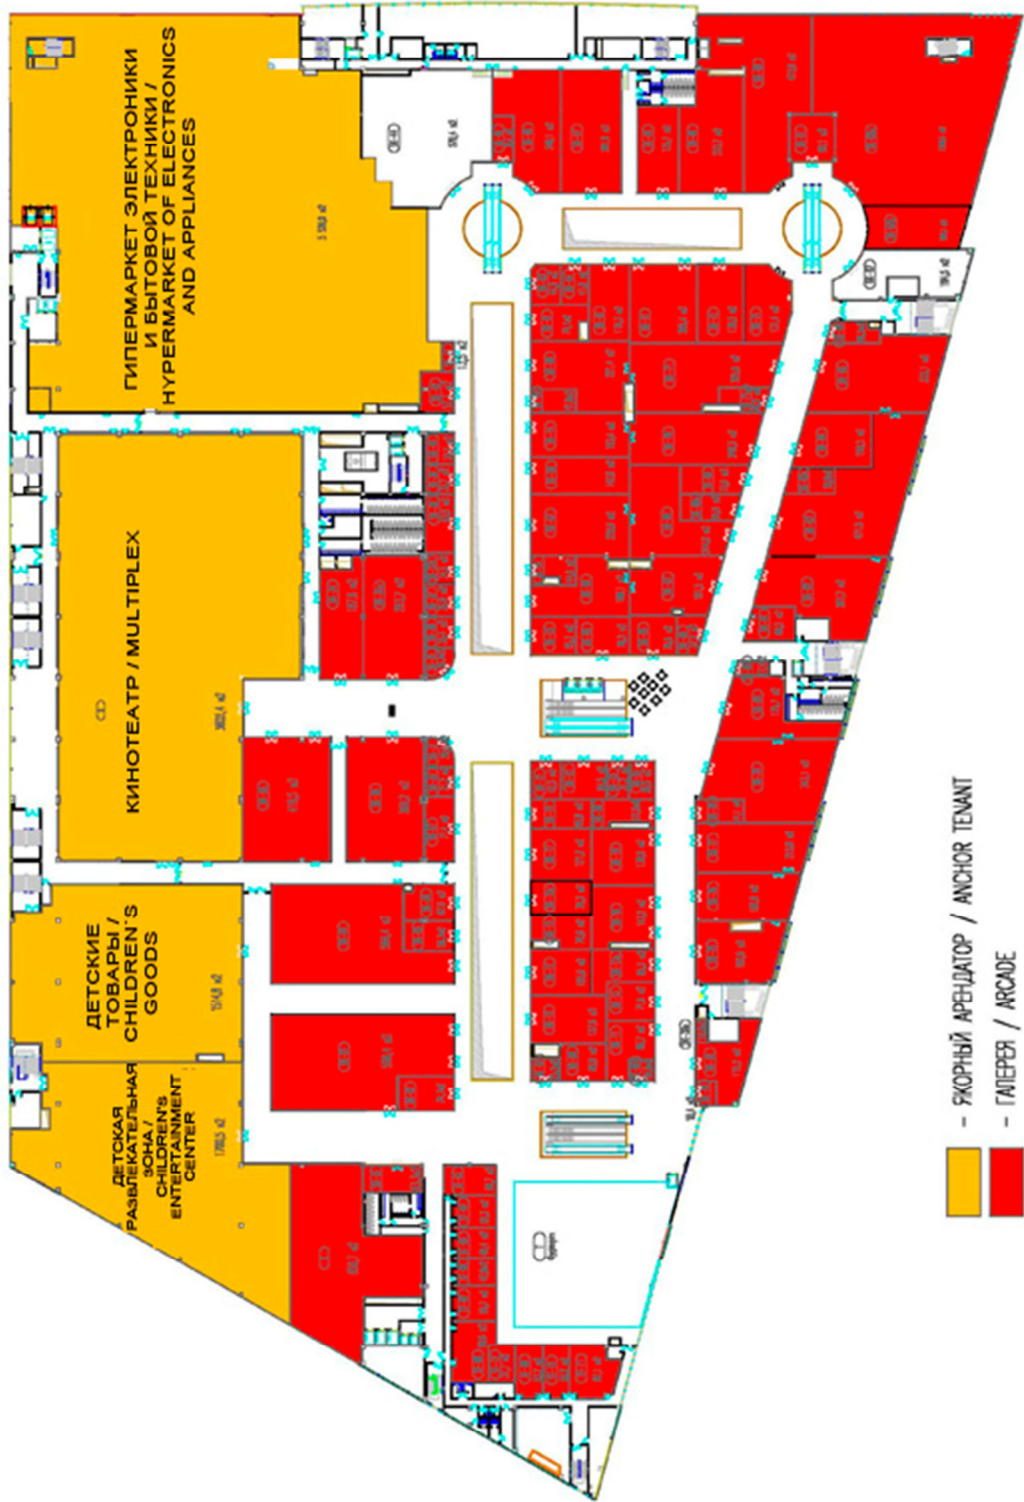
Общий план 2-го этажа ТРЦ «Нарус» г. Москва
